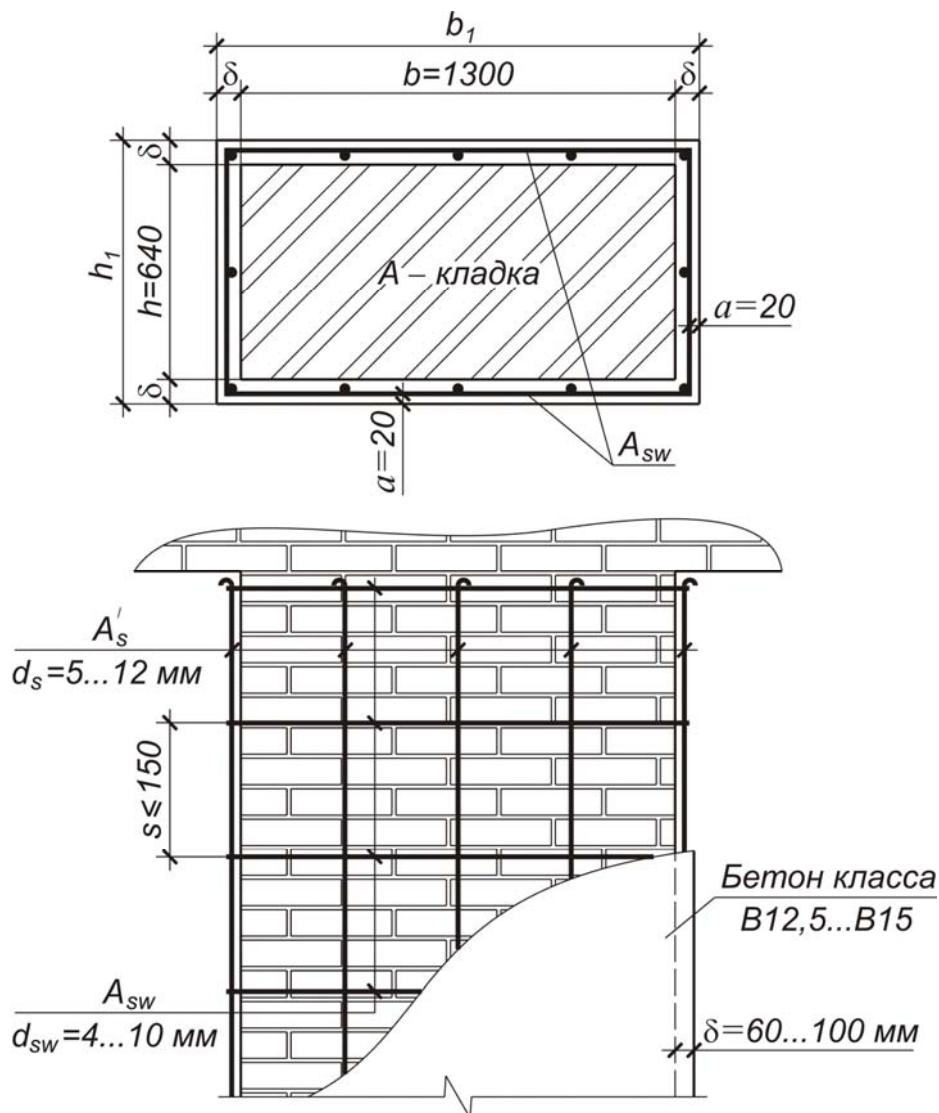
Схема усиления простенка железобетонной обоймой
